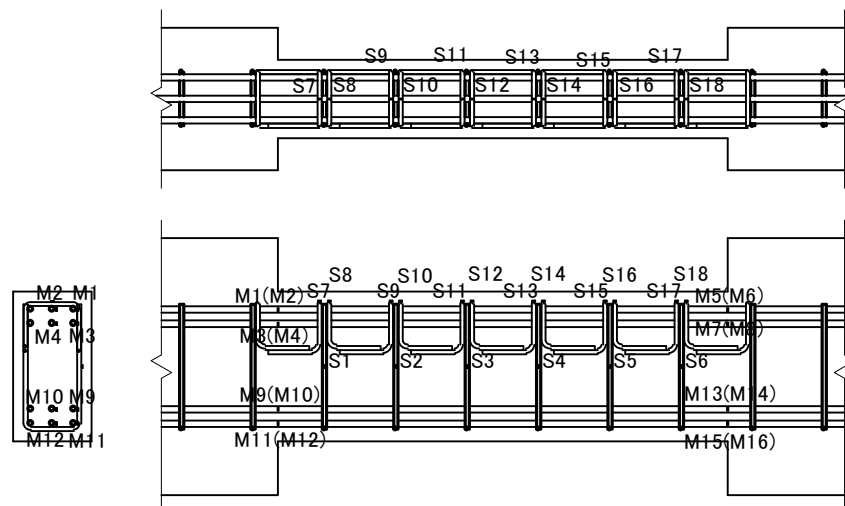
シリーズ1 基礎梁実験のひずみゲージ位置図
